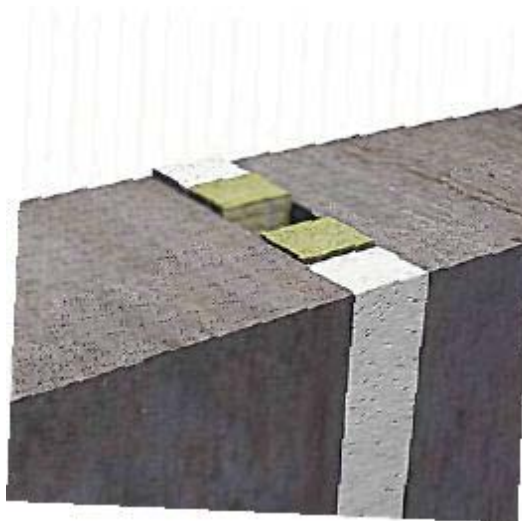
, sello de penetración en junta de dilatación entre muros de mampostería
